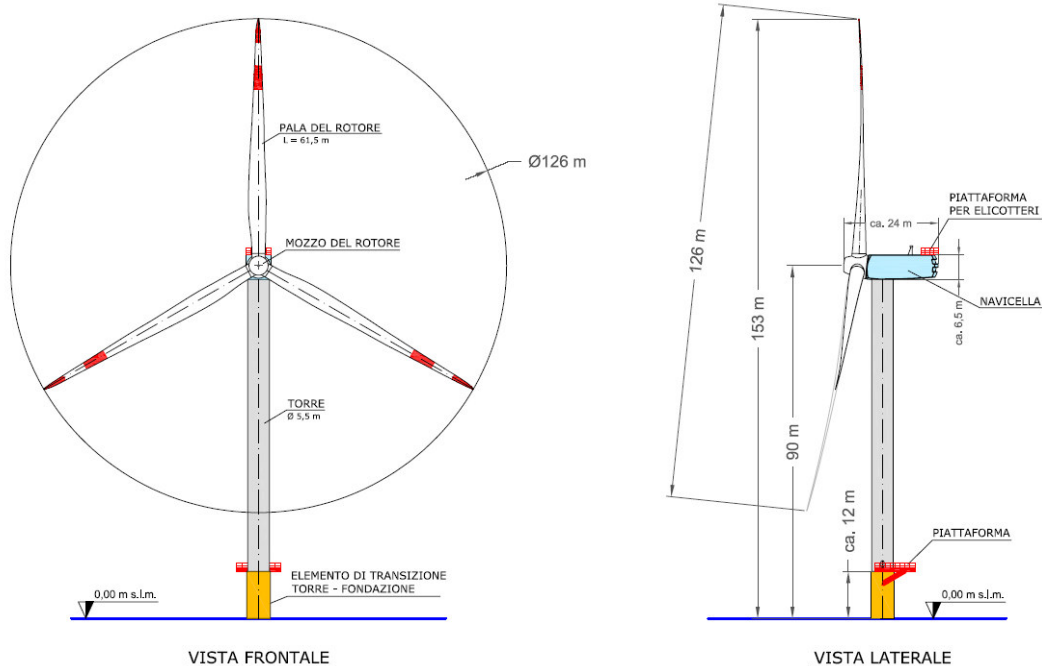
Prospetto frontale e laterale dell'aerogeneratore di progetto.
